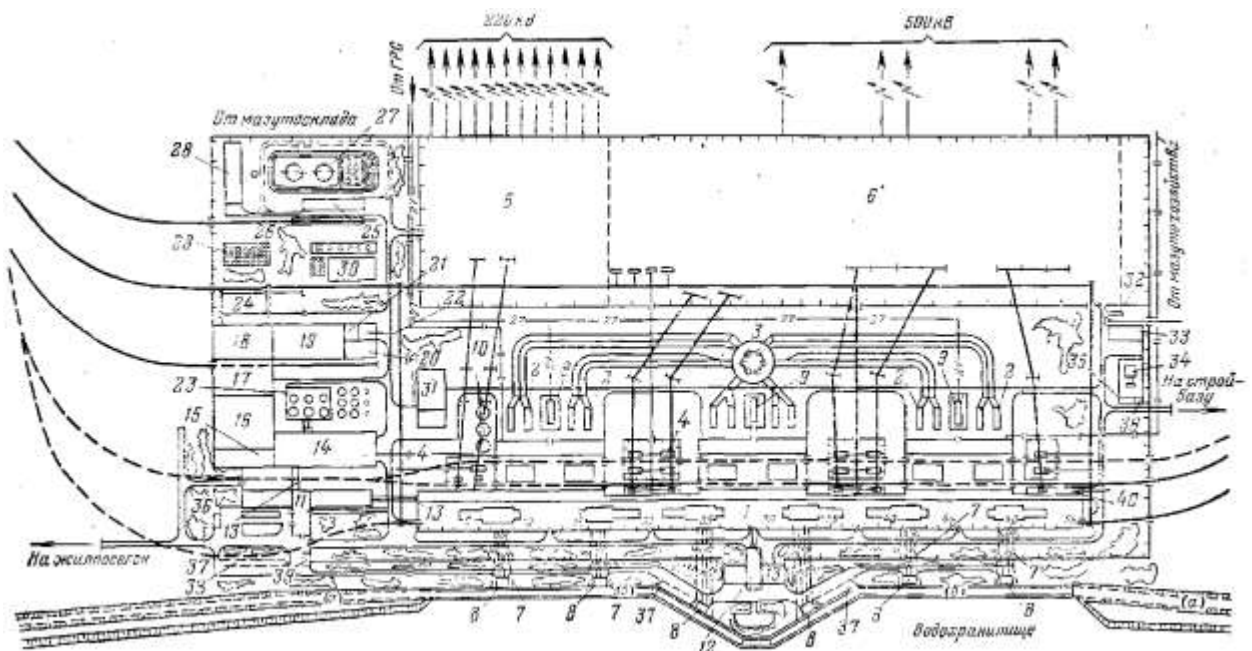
Генеральный план газомазутной электростанции 4800 МВт с зубчатой компоновкой главного корпуса:
